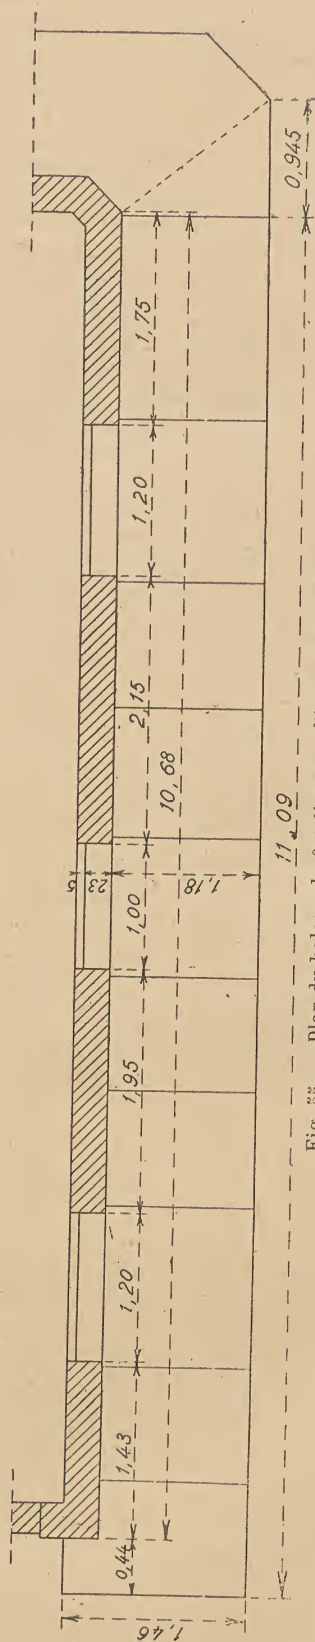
Plan du balcon du 6<sup>me</sup> étage sur l'impasse du Cadran.
